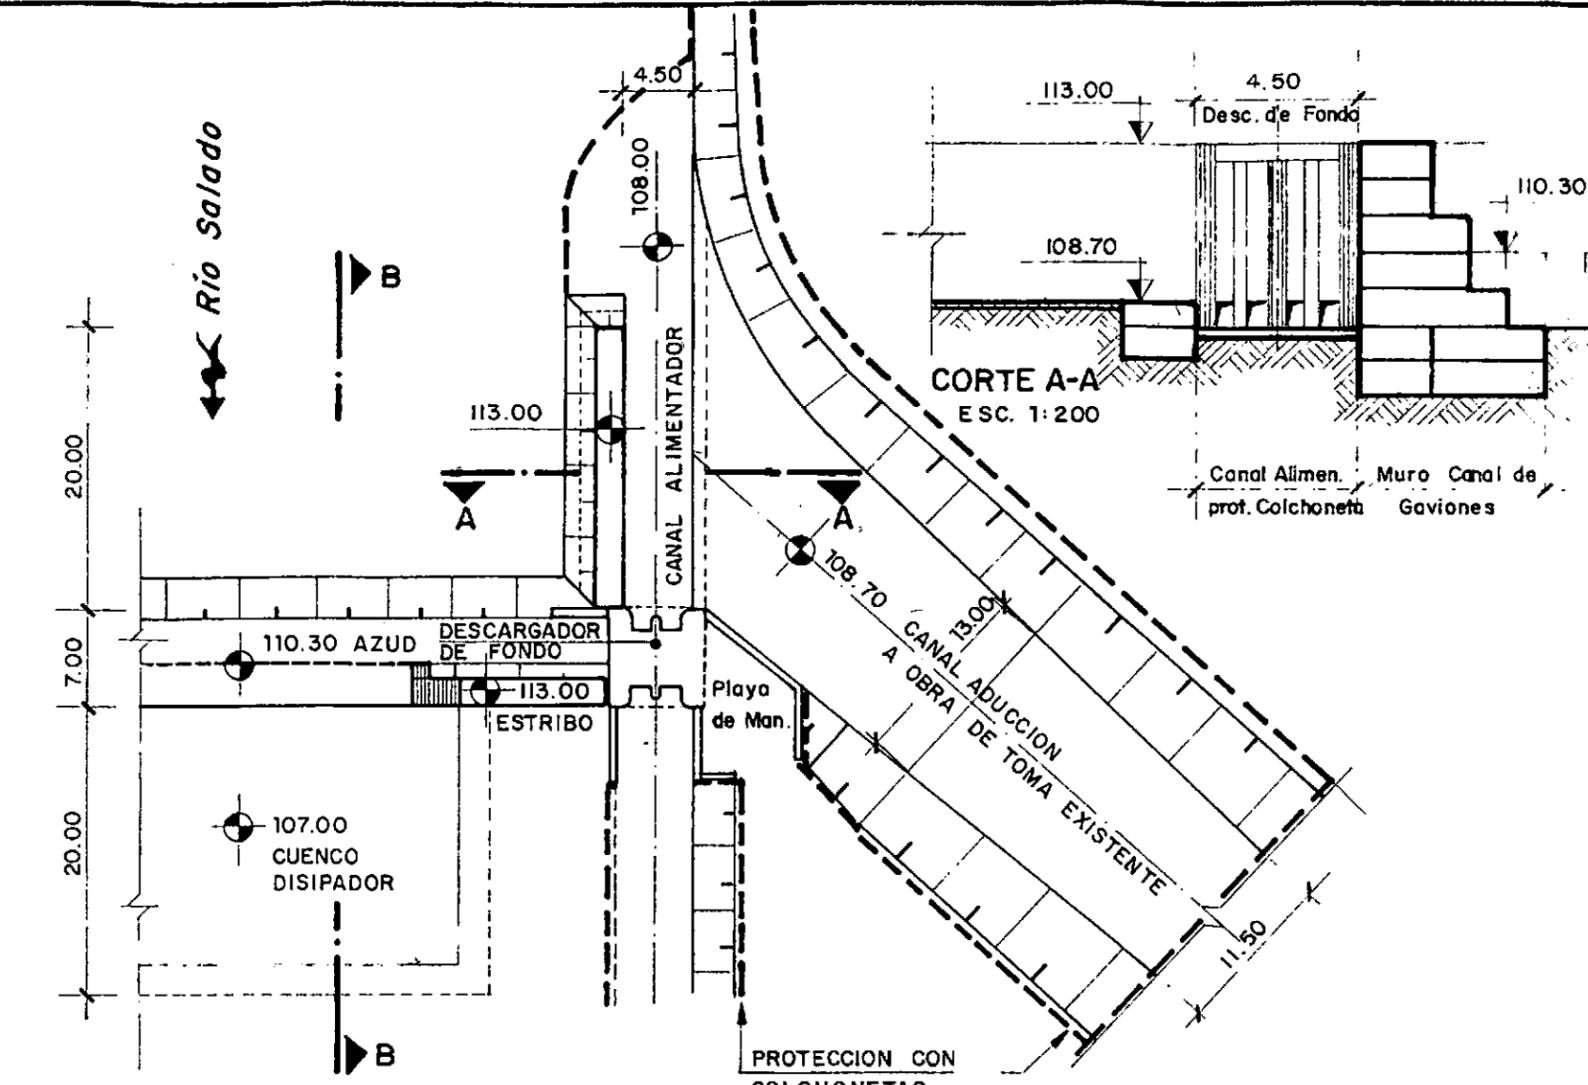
ALTERNATIVA 1 VARIANTE B
